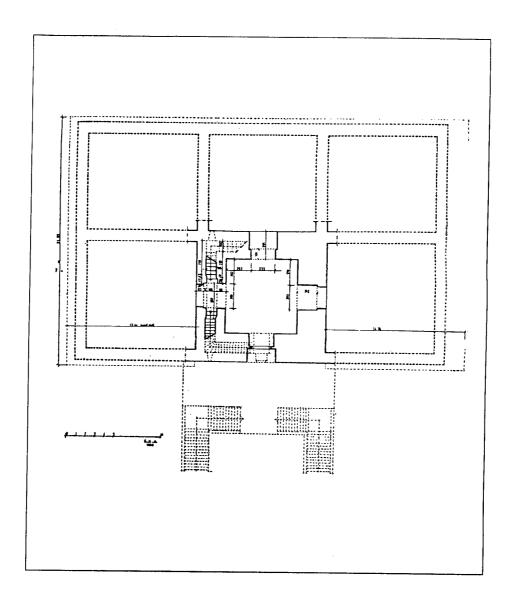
مسقط أفقي لخان مورياكا في سراييفو (عن :Cezar).
